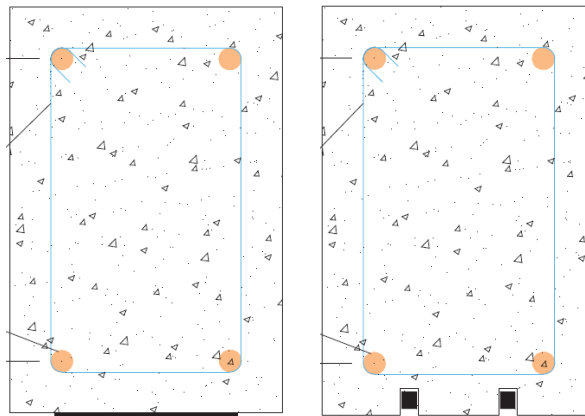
Vigas reforzadas con láminas adheridas externamente EB-FRP y barras inseridas en canaletas NSM [Mahal M., T. Blanksvärd, B. Täljsten (2015)]
